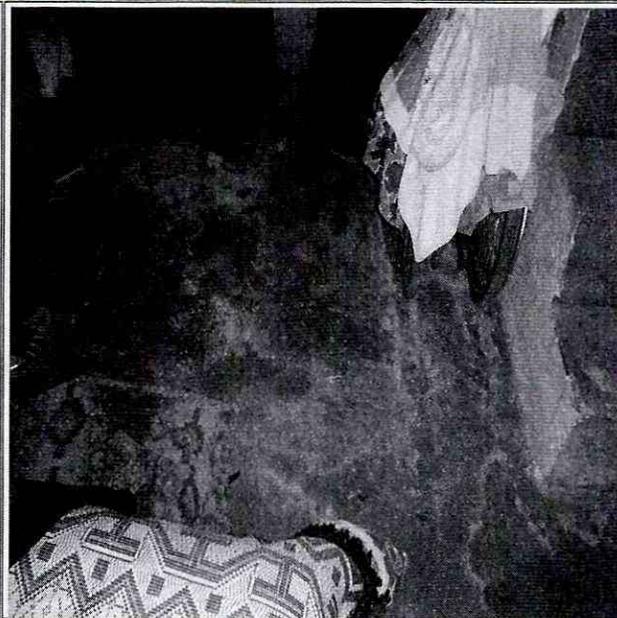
Humedades en pisos y muros de las viviendas del Barrio Naciones Unidas Santa Rosa
